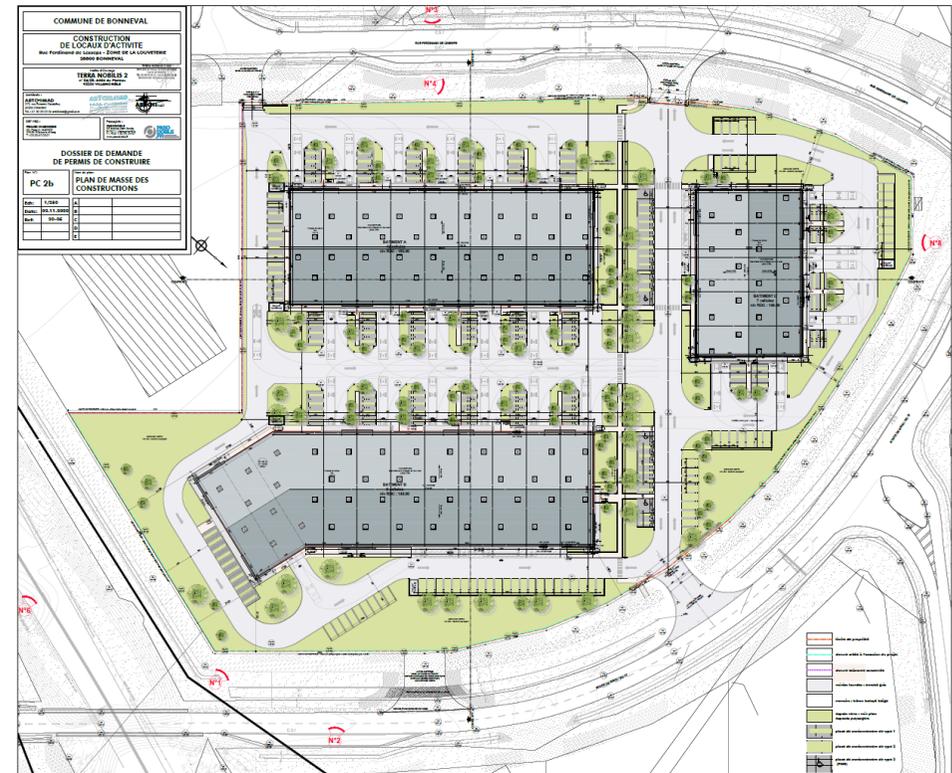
Plan masse du secteur 1 "zone artisanale"
